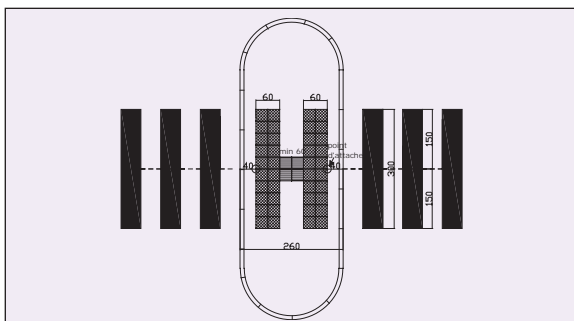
et 2: implantation type des dalles dans des traversées avec petits îlots rectangulaires. © GAMAH
